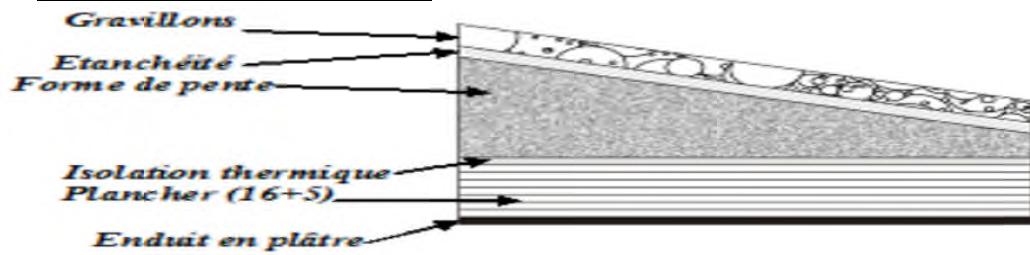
Constituants de la dalle de la terrasse inaccessible
